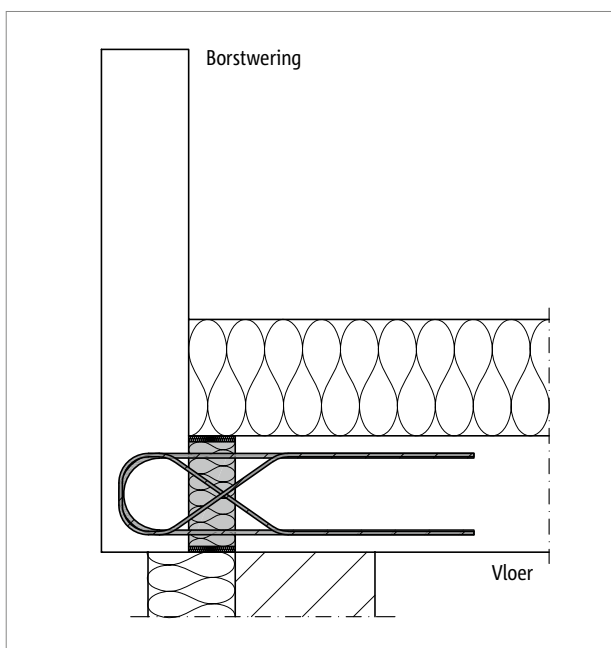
Schöck Isokorb® T type A horizontale toepassing: Zijaanzicht borstwering voorgeplaatst
